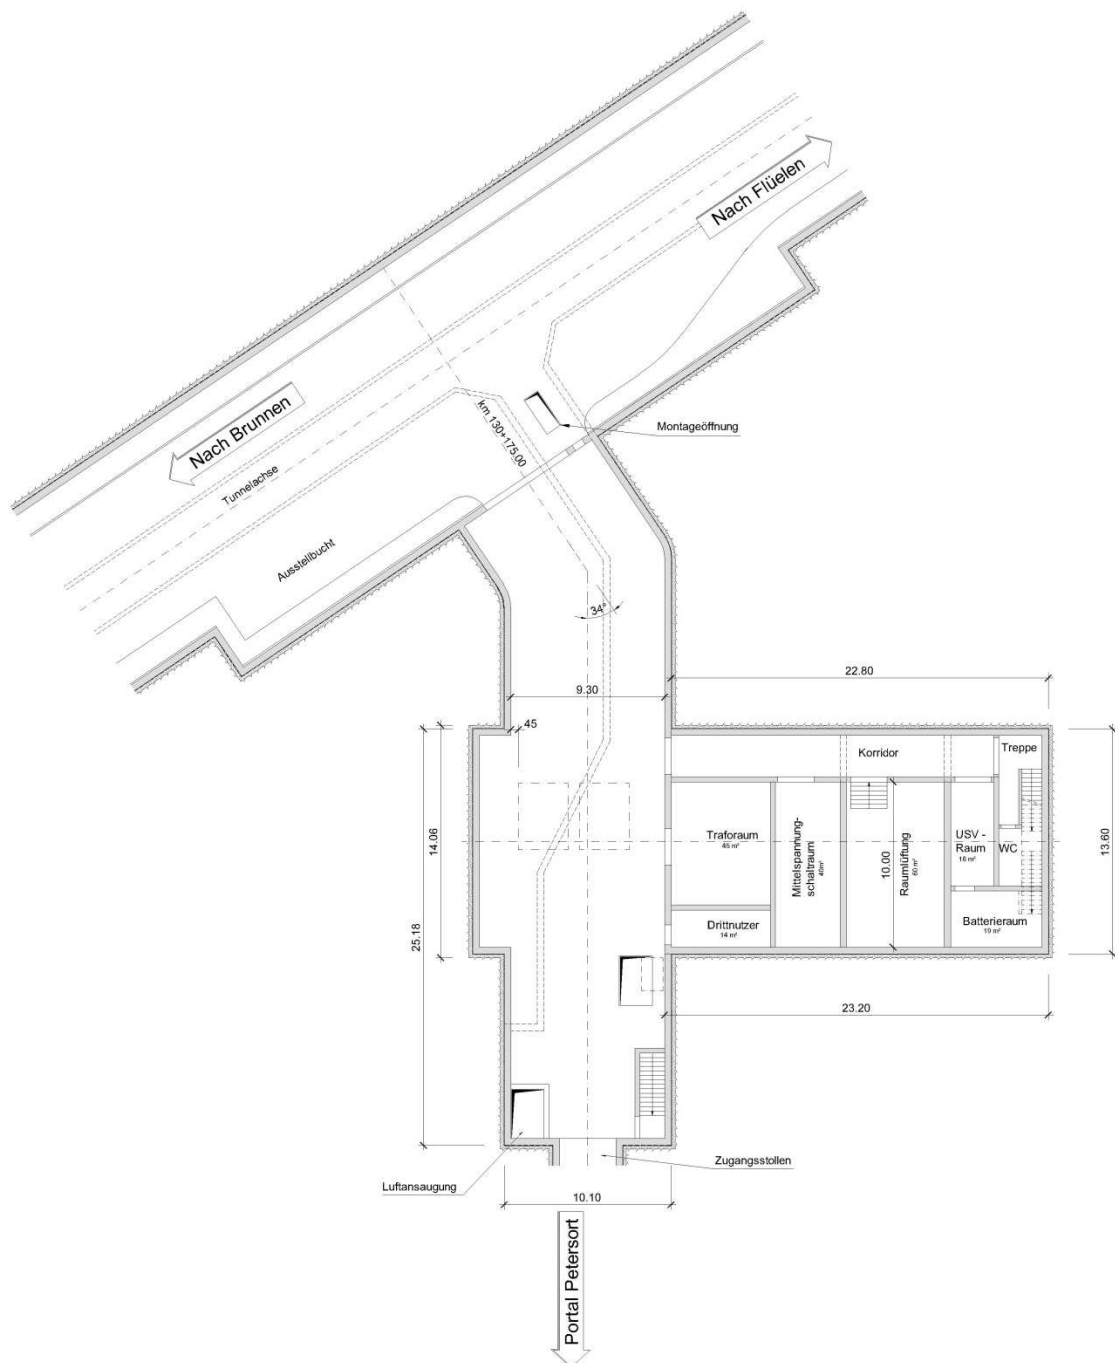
Grundriss Erdgeschoss Lüftungszentrale Petersort
